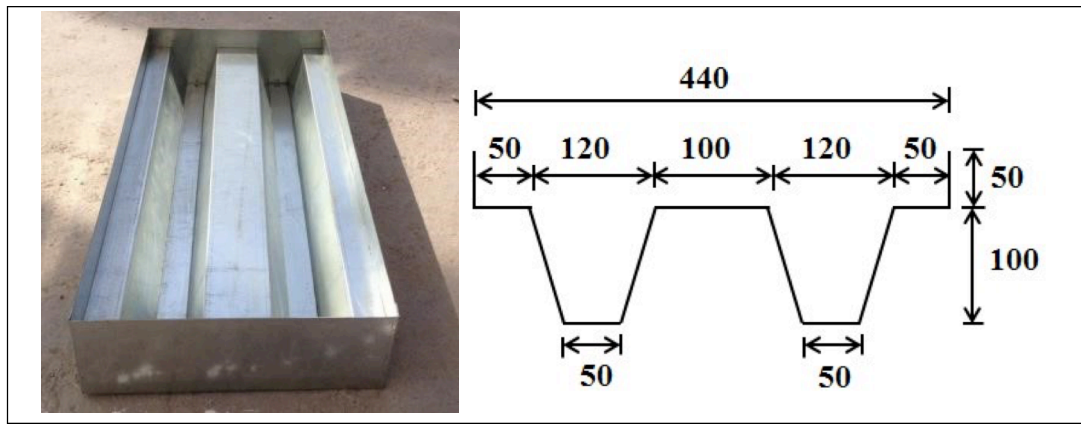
Molde de acero galvanizado y dimensiones de las secciones (en mm) para los paneles nervados
